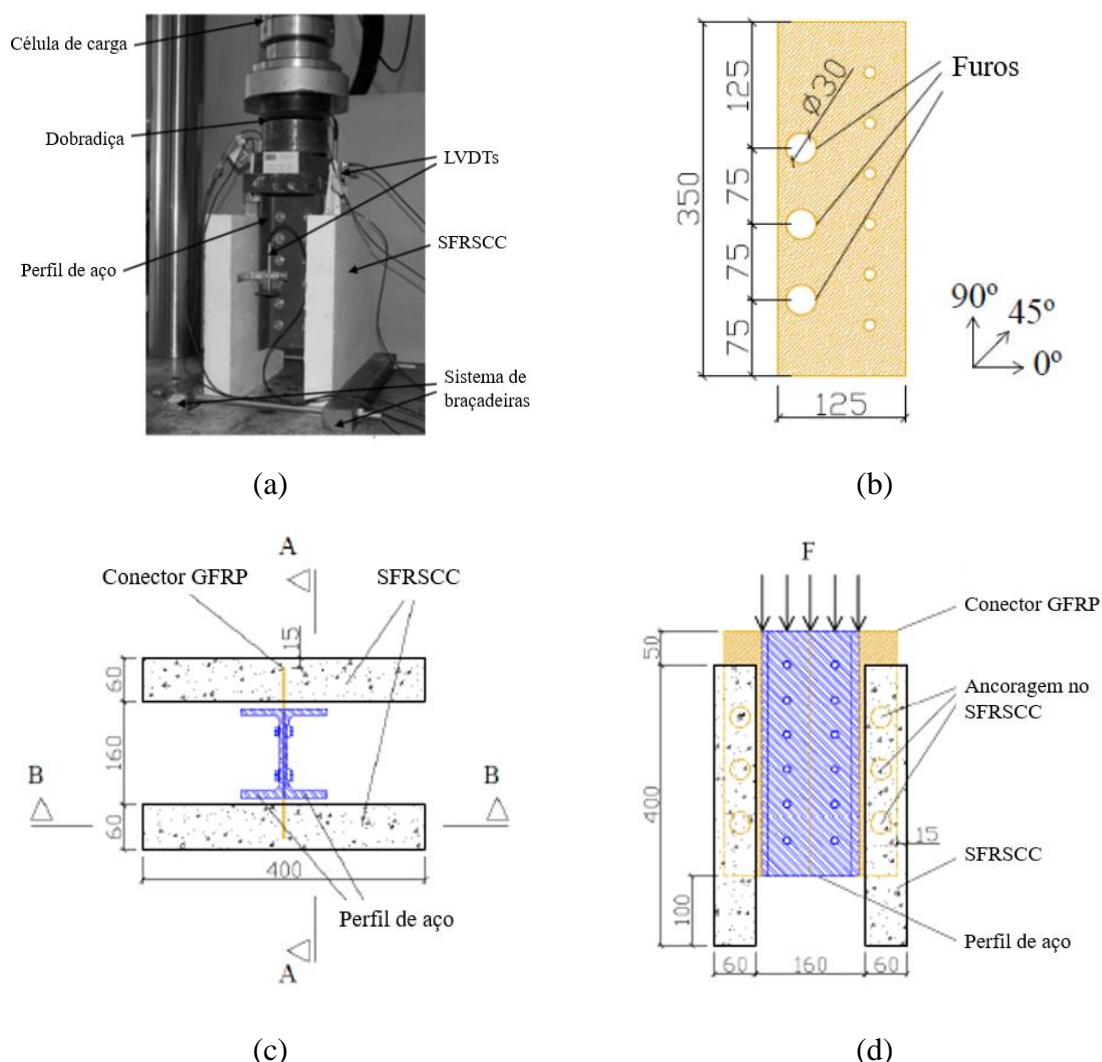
Ensaio *push-out* (dimensões em mm): (a) configuração do ensaio; (b) conector PerfoFRP; (c) vista em planta do corpo de prova; (d) Corte AA do corpo de prova. Adaptado de Lameiras, 2015.
